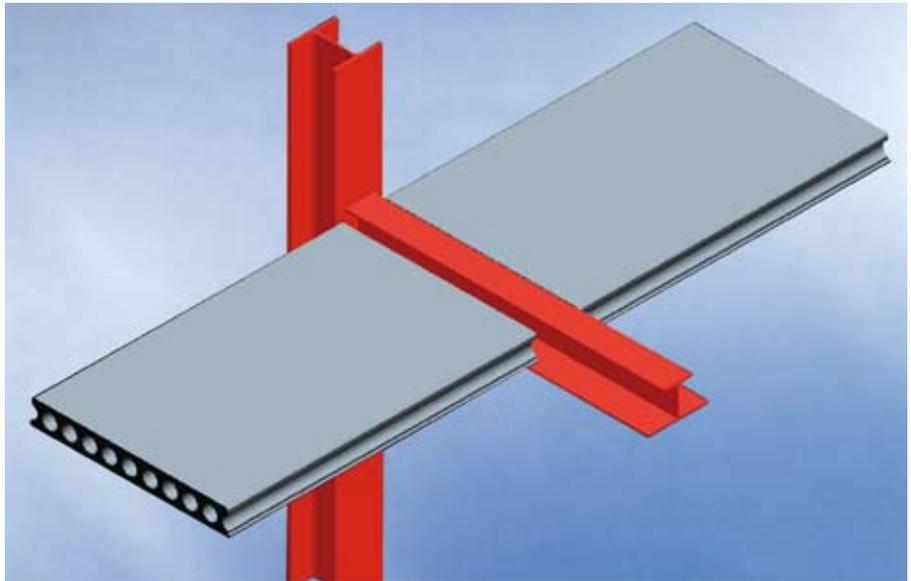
Poutres intégrées de plancher supportant des dalles préfabriquées en béton
